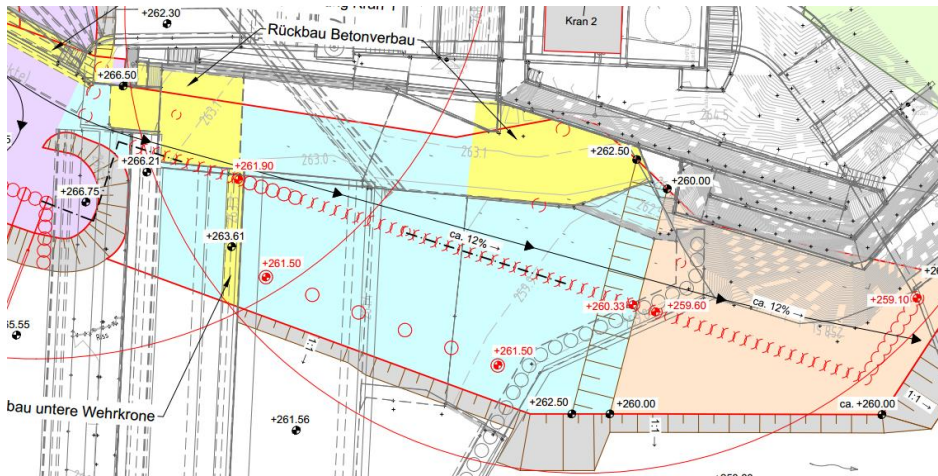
Situationsauszug aus dem Plan „Situation Bauetappe 1“, Plan-Nr. 1010-021-018
